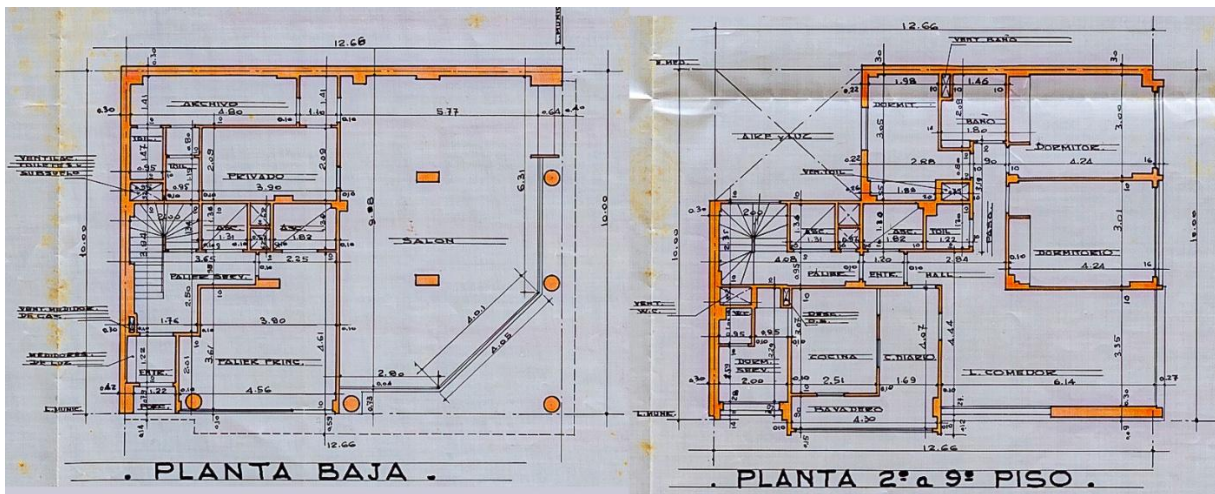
Edificio Amancay (Rassia y Cossio, 1958). Planta baja y planta de 2° a 9° piso. Fotografías: Walter Salcedo. Composición del autor.
